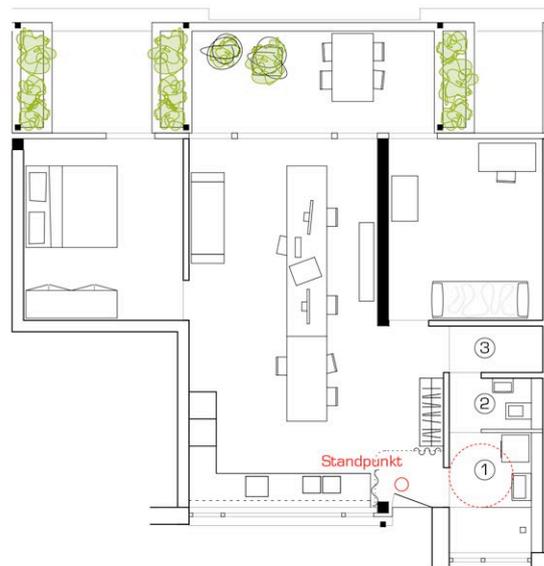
Grundriss und Nutzungsvariante 3.5 Zimmer Wohnung
